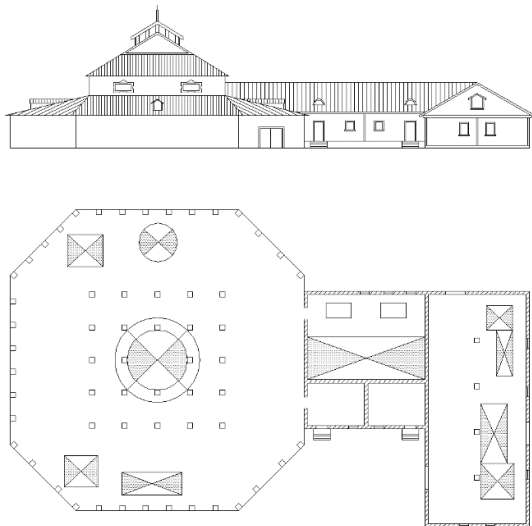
Фасад и план стекольного завода в Поречской пуще, 1914 г.
